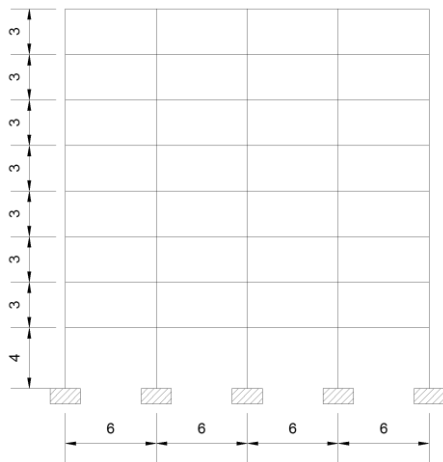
Elevación tipo de la estructura sentido largo (cotas en m)
